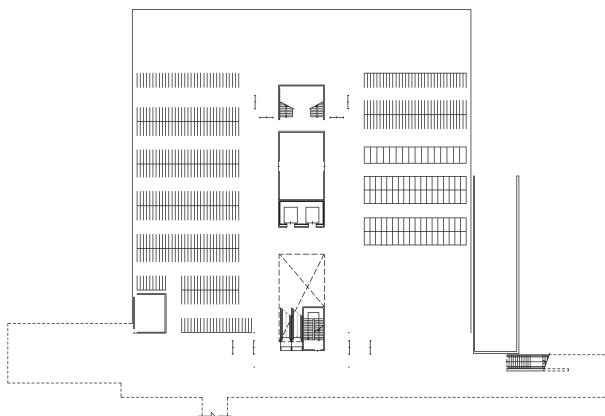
ホール棟平面図（地下 1 階～地上 4 階）
